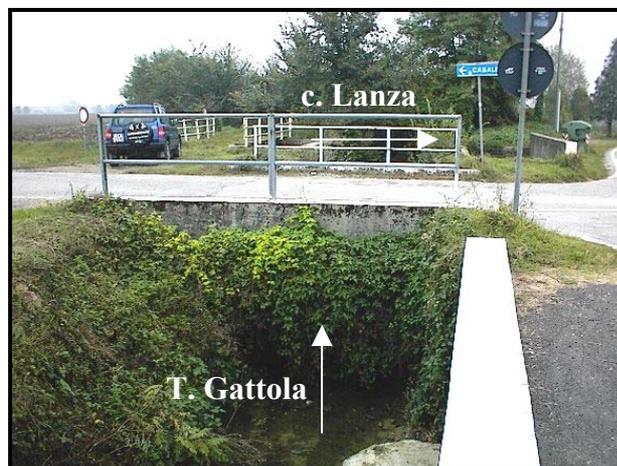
Vista da monte del ponte sul Gattola, prima di incontrare il canale Lanza.
